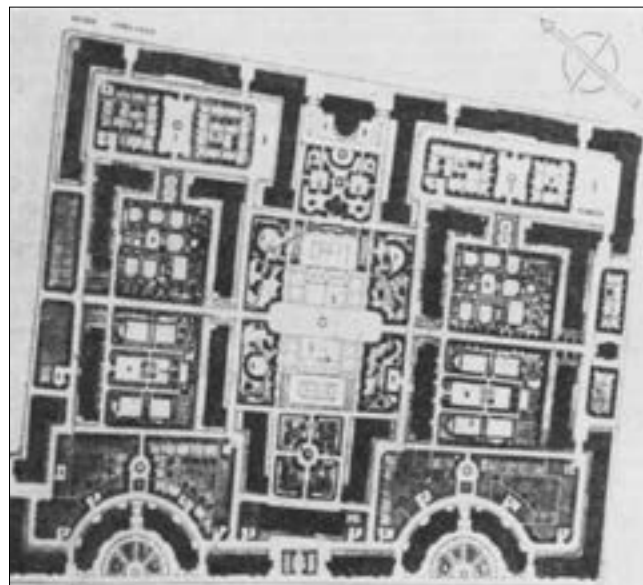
Проект жилого квартала с размещением детских садов на первых этажах жилых зданий [9]
